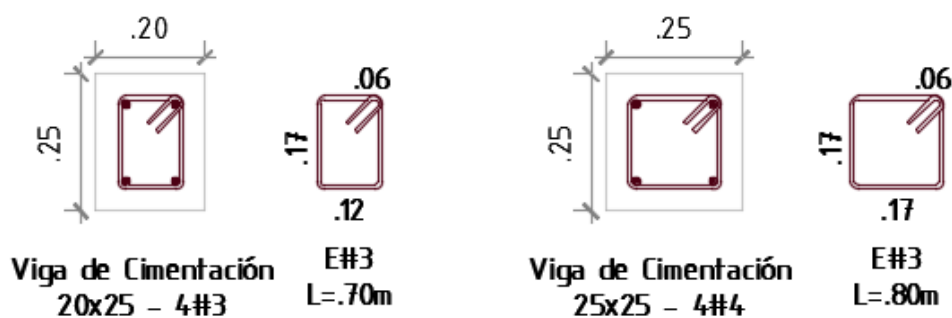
Detalle de refuerzo de vigas de cimentación (a nivel de terreno)
